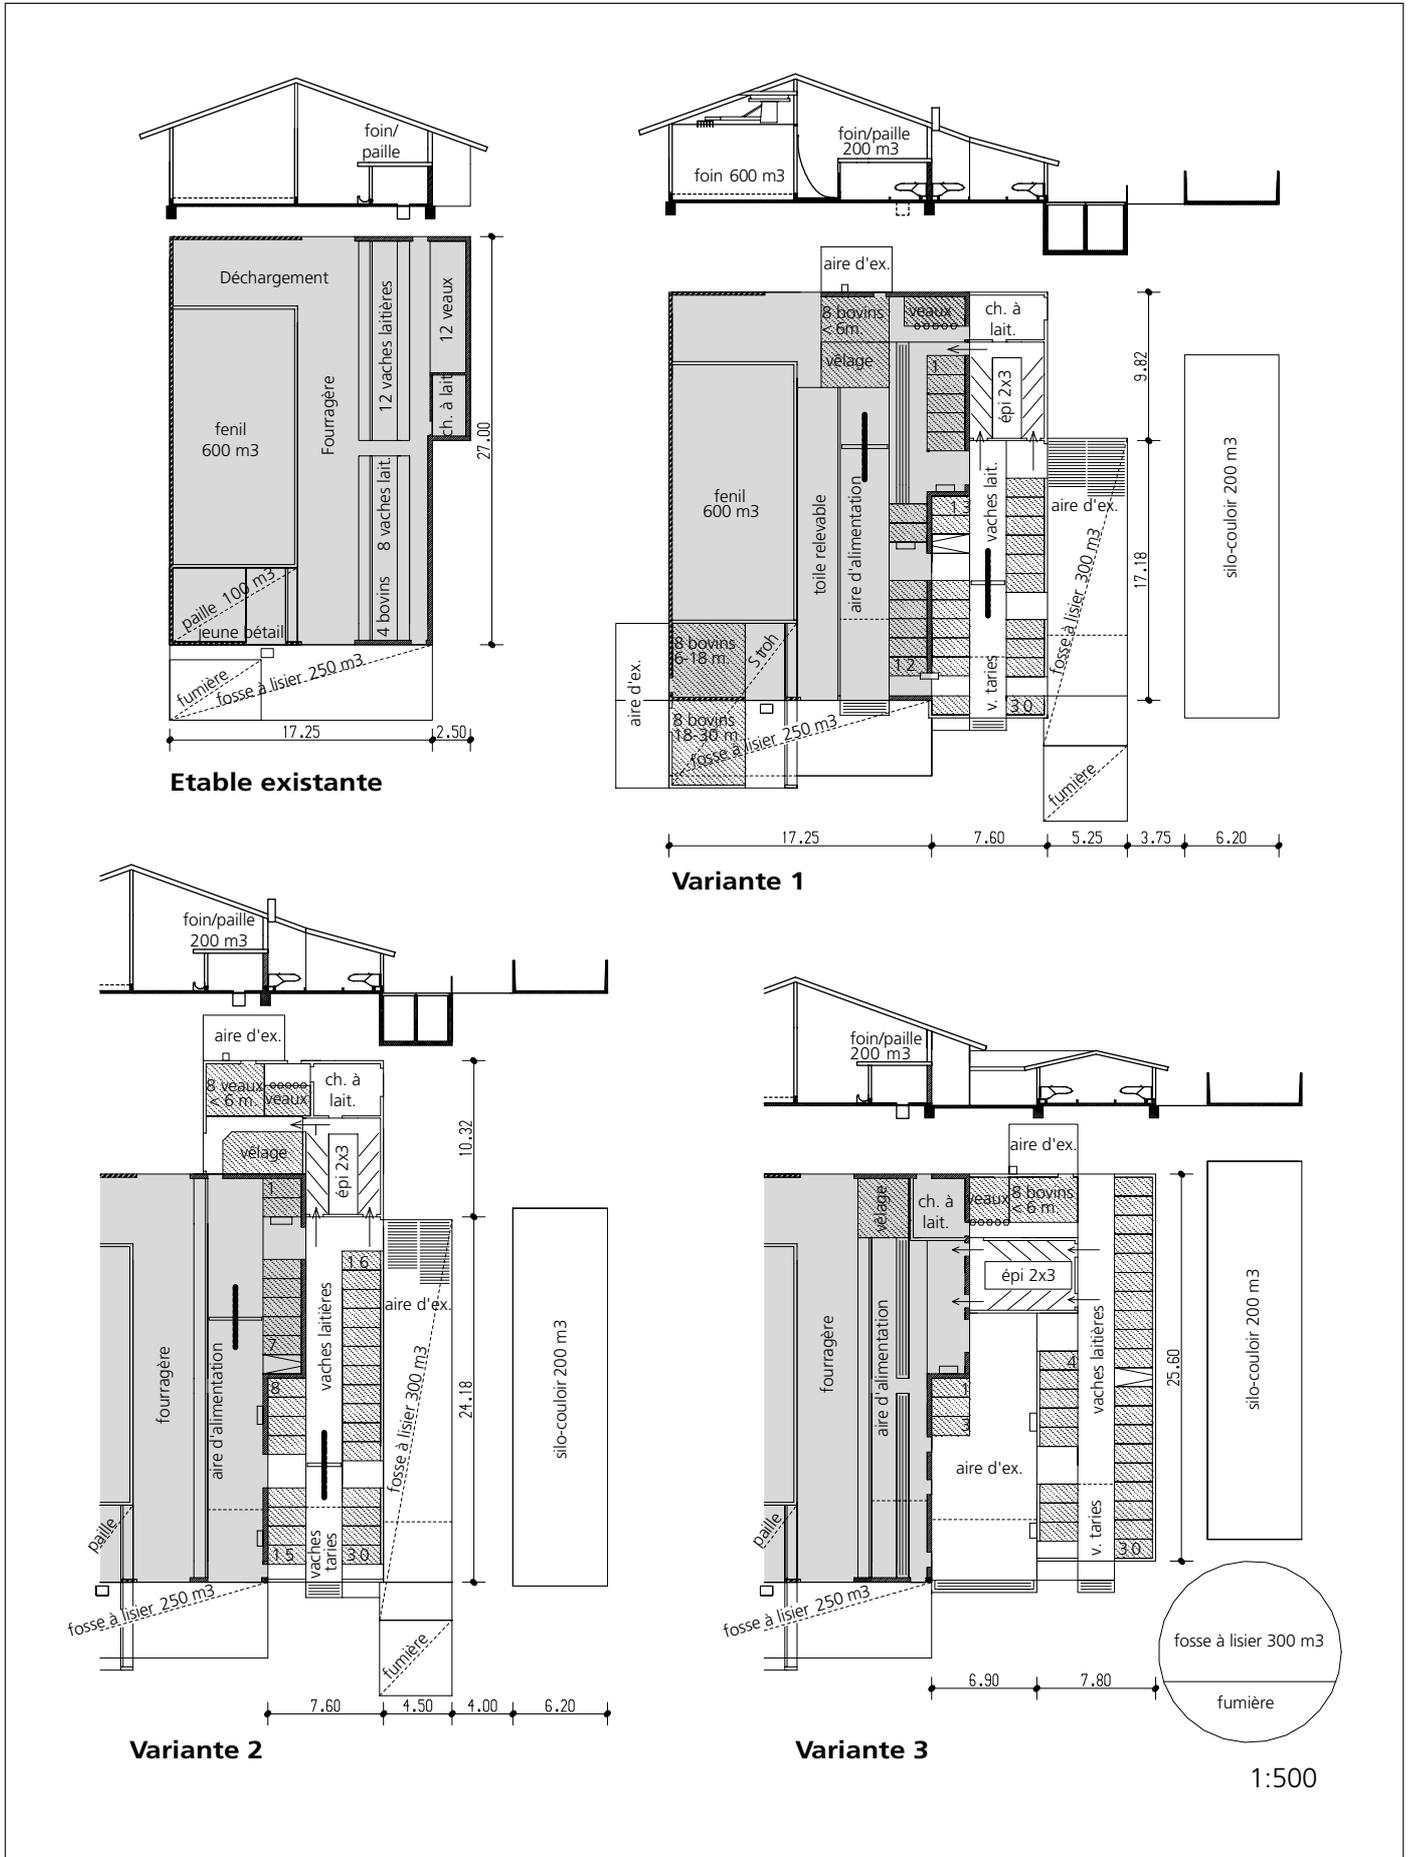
Exemple 3. Solutions de construction pour une étable construite en longueur avec stockage du fourrage sur le côté.
